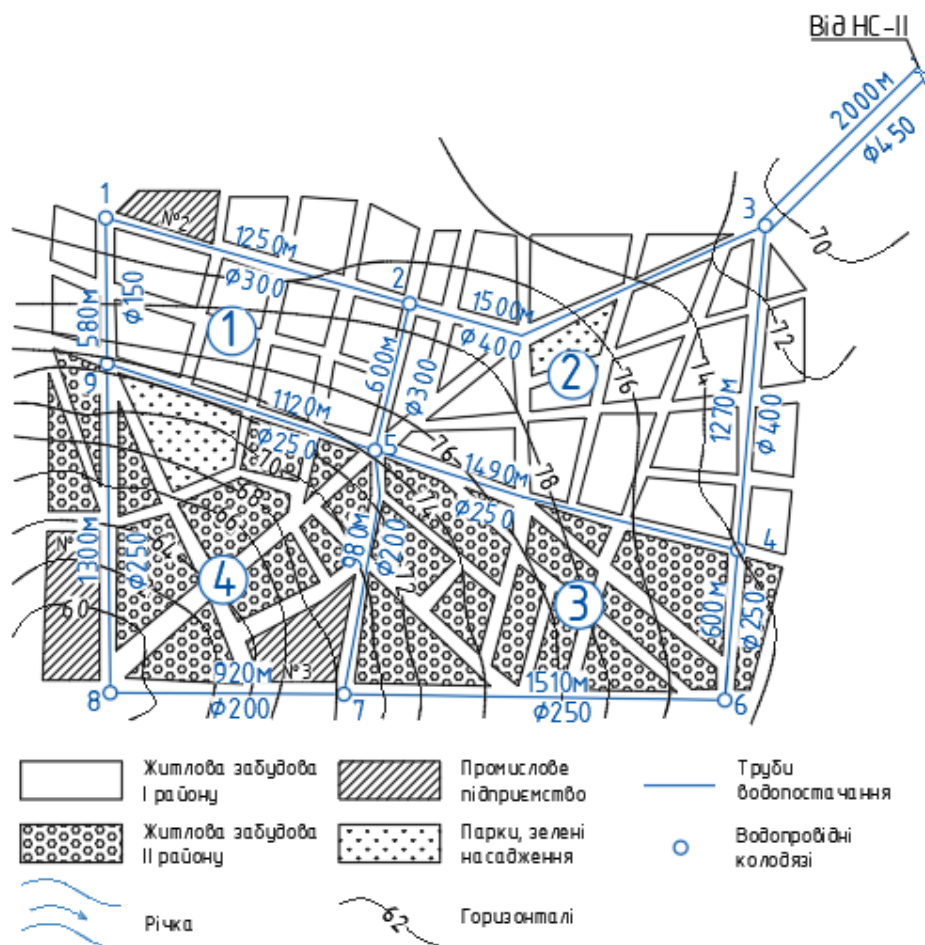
Траса магістральної водопровідної мережі і водоводів
